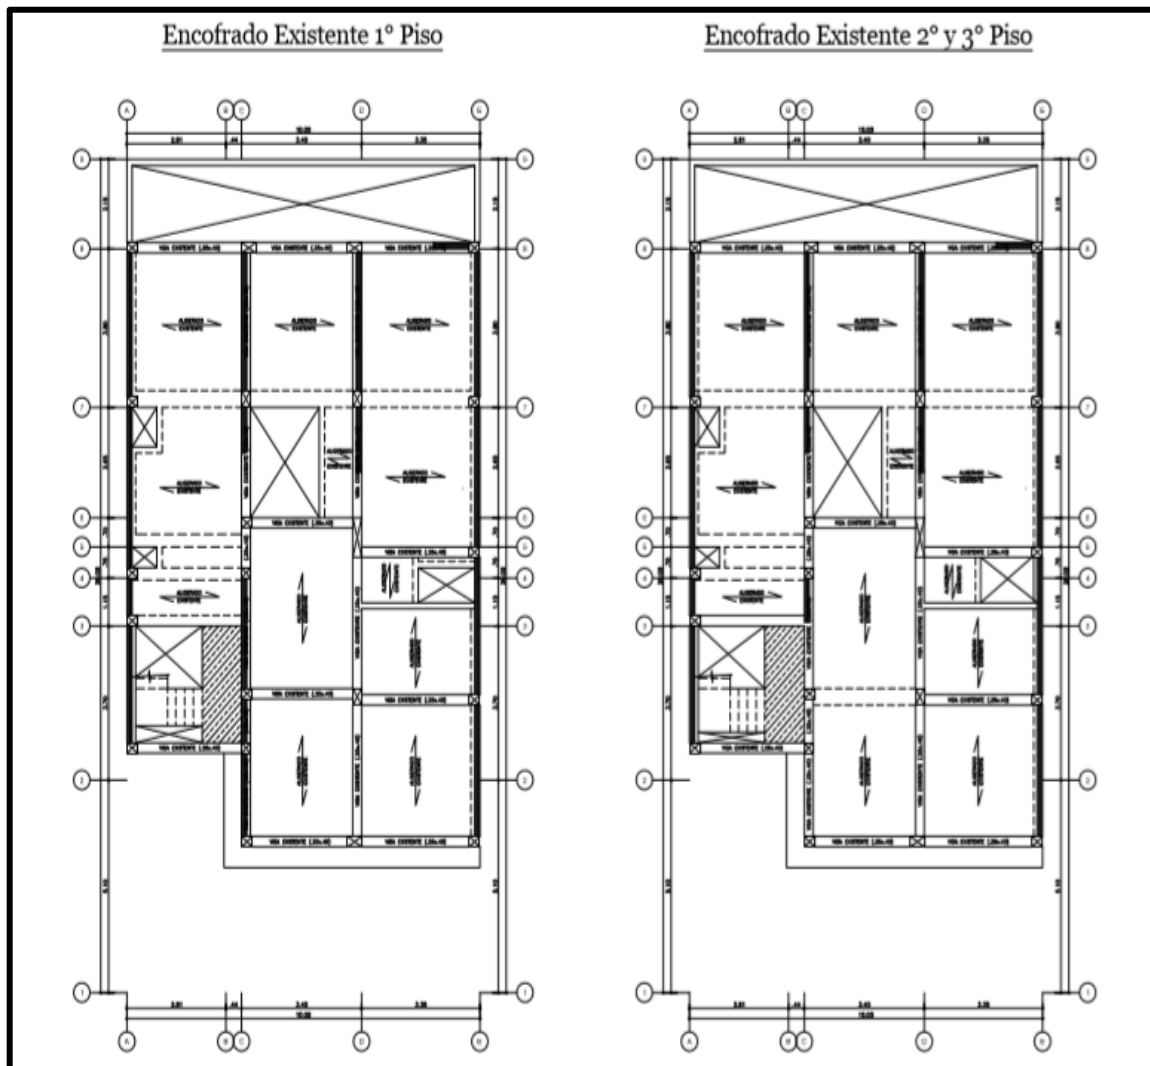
Planos de estructura existente de la edificación, pisos 1, 2 y 3. Donde se observa los todos los elementos estructurales.
